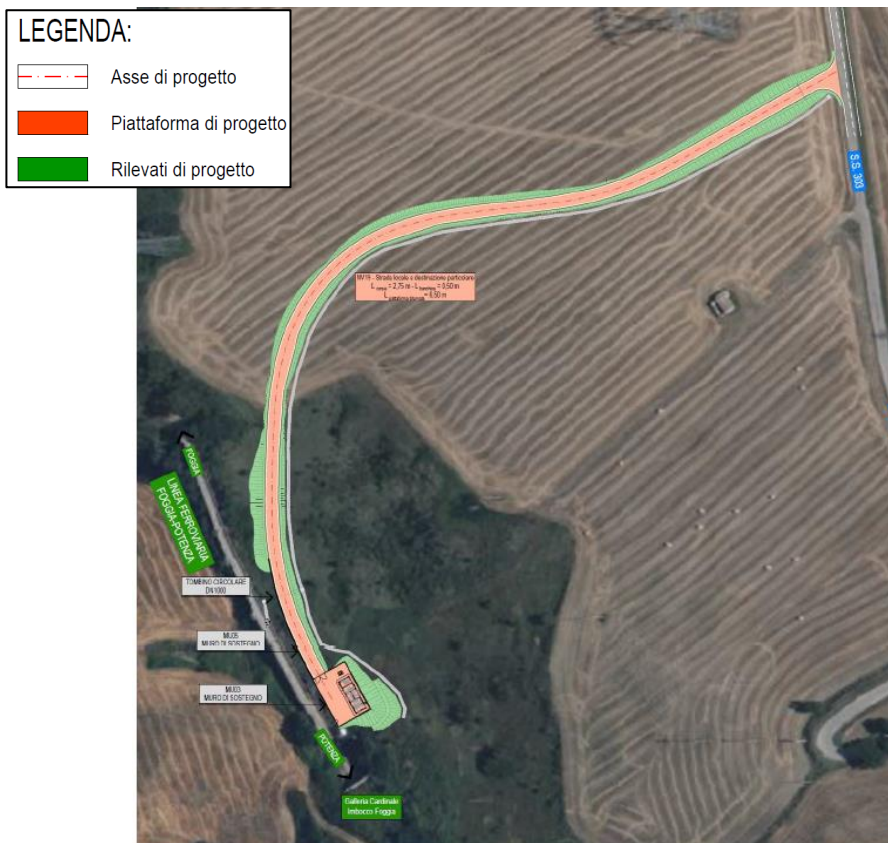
Planimetria di progetto su ortofoto - Viabilità NV 19
